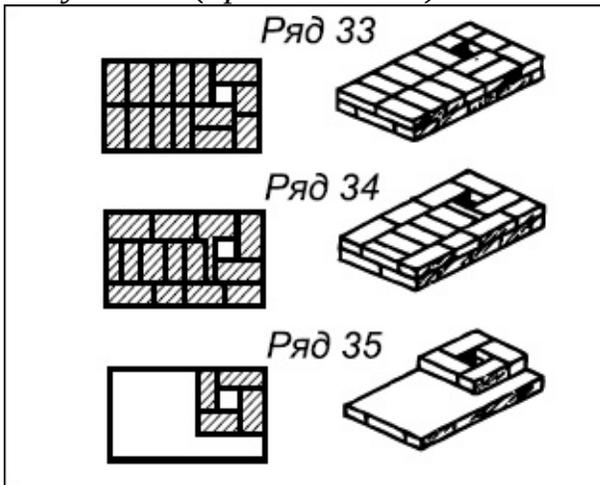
(окончание). Кладка отопительной прямоугольной печи
